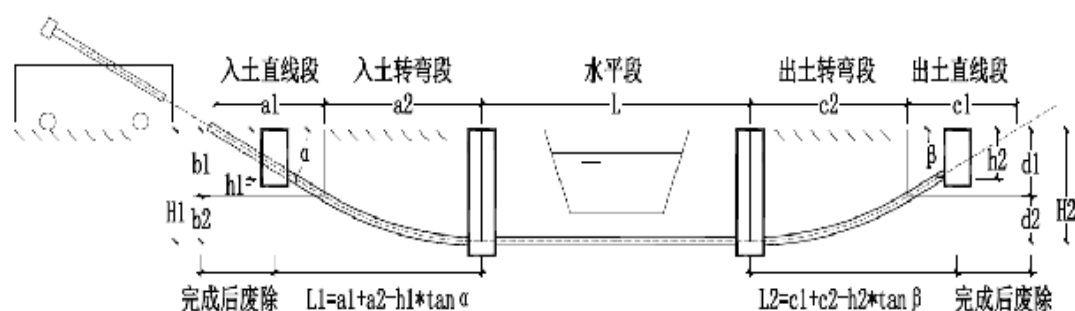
非开挖定向钻(拖管)施工断面示意图
